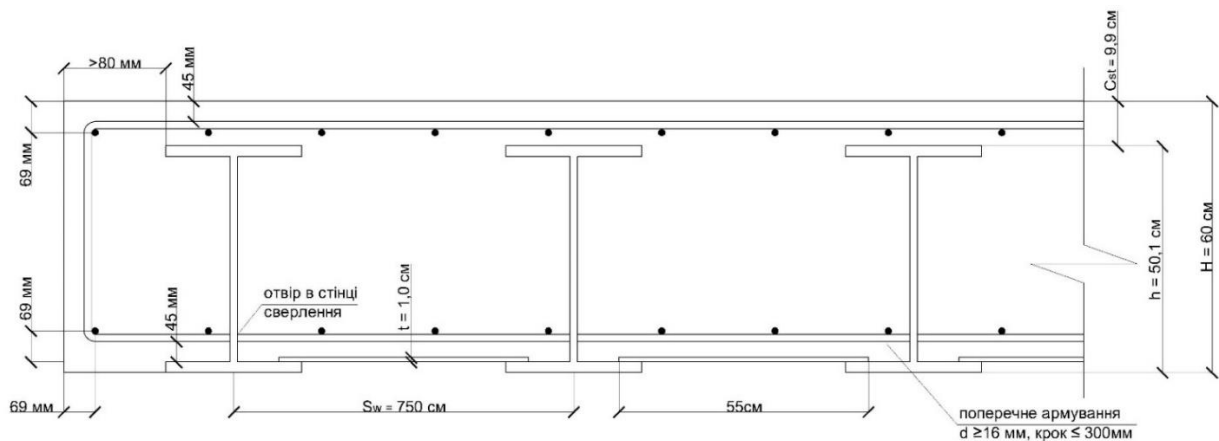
Фрагмент плити прогонової будови у поперек мосту
